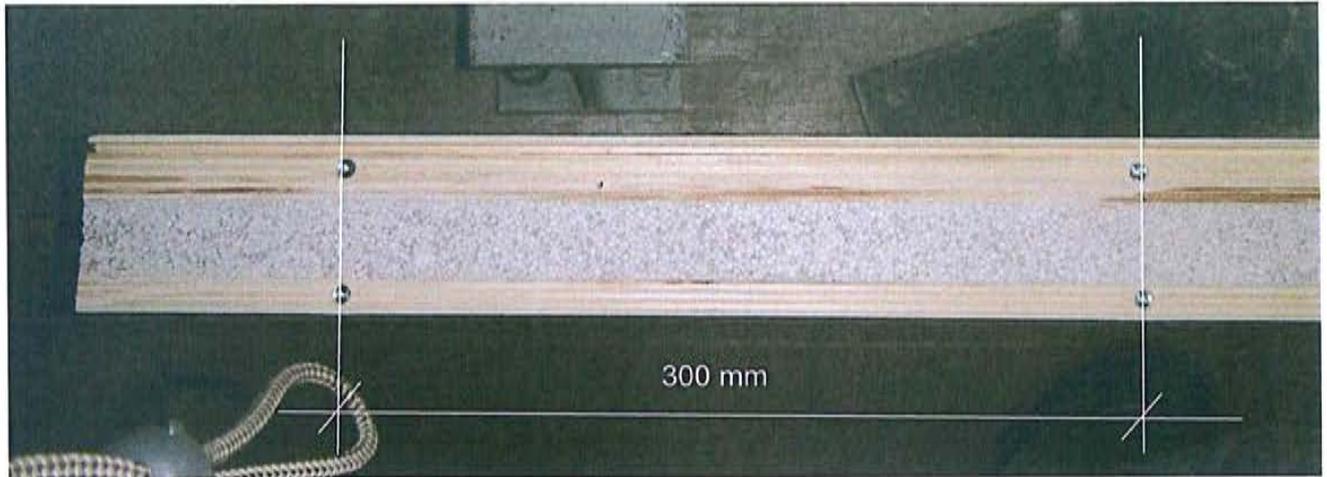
Rückansicht zum Versuch Nr. 111. Das Holzprofil ist mit vier Schrauben je Befestigungspunkt mit dem SDP verschraubt. Der Abstand der Verschraubung beträgt $e = 300$ mm. Der Probekörper hat eine Länge von $l = 400$ mm
